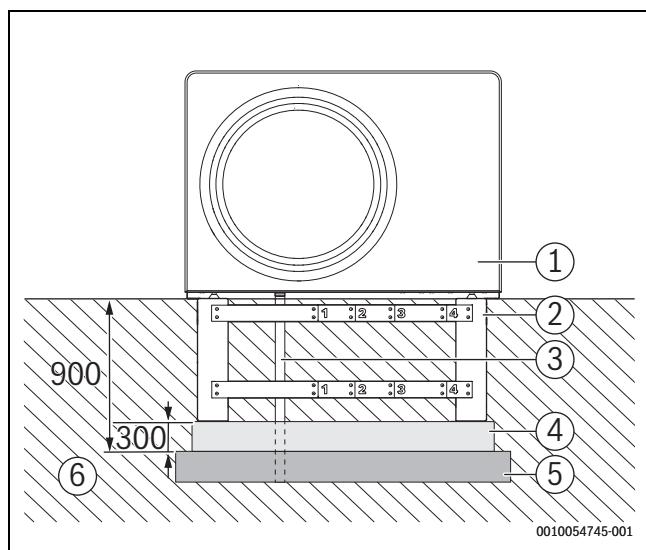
Esempio di installazione: fondazione prefabbricata nel terreno
